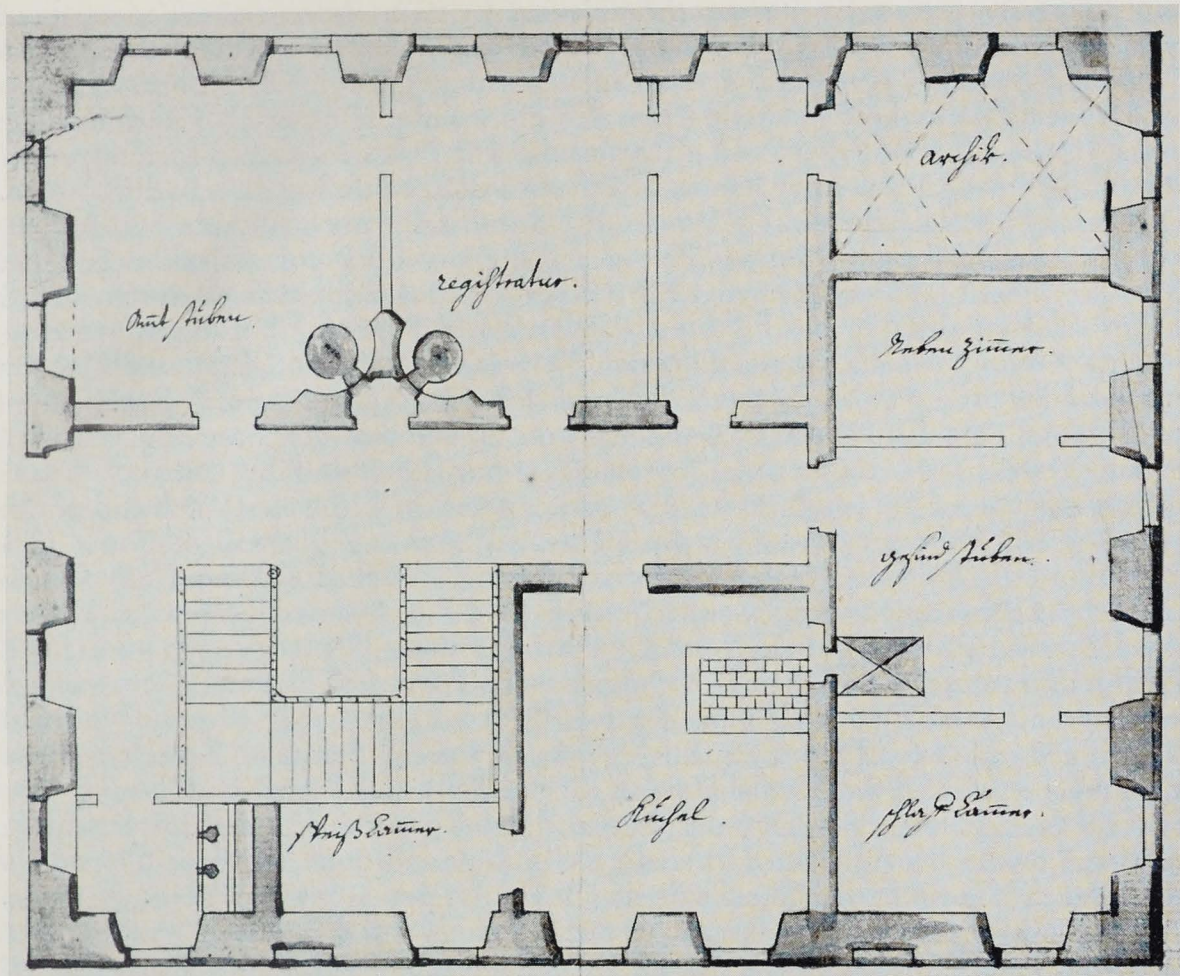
Plan des neuen Amthaus von Joseph Hirschpiehl 1765, Grundriß Erdgeschoß (GLA 186/18).
